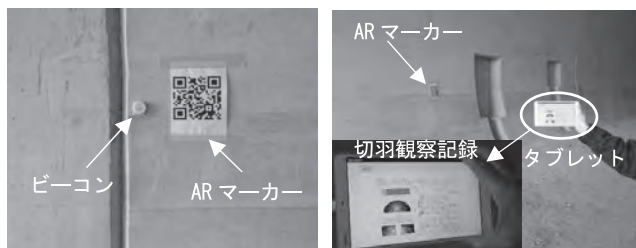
ARマーカ―、ビーコン設置状況 写真-2 2次元データの出力表示
